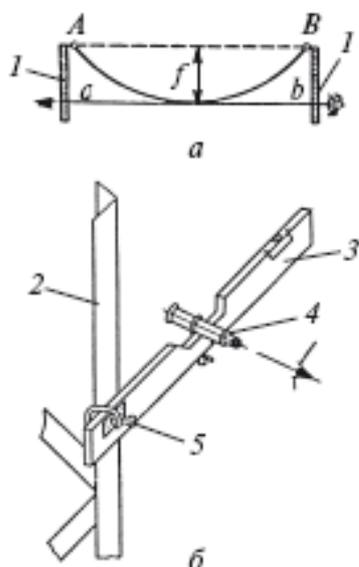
Схема визирования проводов (а) и приспособление для визирования проводов (б): ab – линия визирования; AB – прямая, соединяющая точки подвеса гирлянд изоляторов; f – стрела провеса провода; 1 – визирные рейки, укрепленные на опорах; 2 – стойка опоры; 3 – рейка с уровнем; 4 – окуляр; 5 – струбцина для крепления
